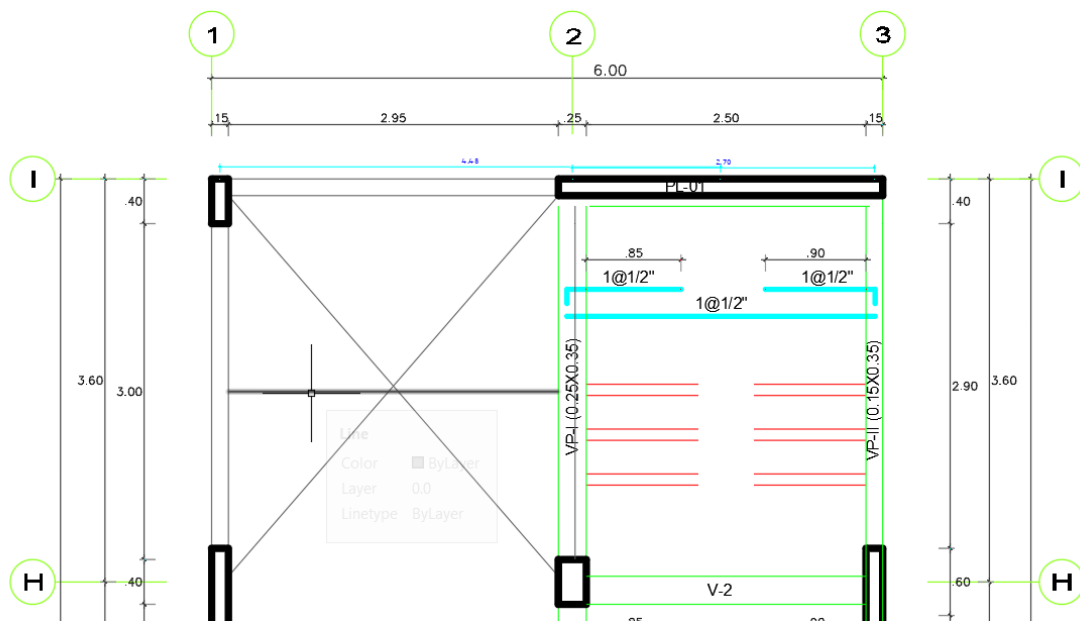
Reforzamiento de losa aligerada en una dirección con un solo paño
